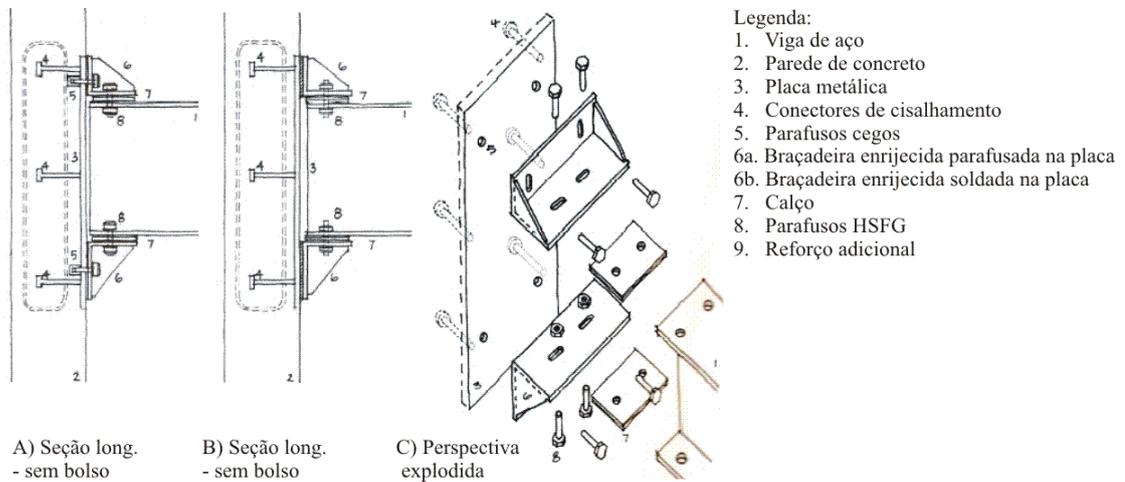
Interface entre viga de aço e parede de concreto com chapuz enrijecido.
